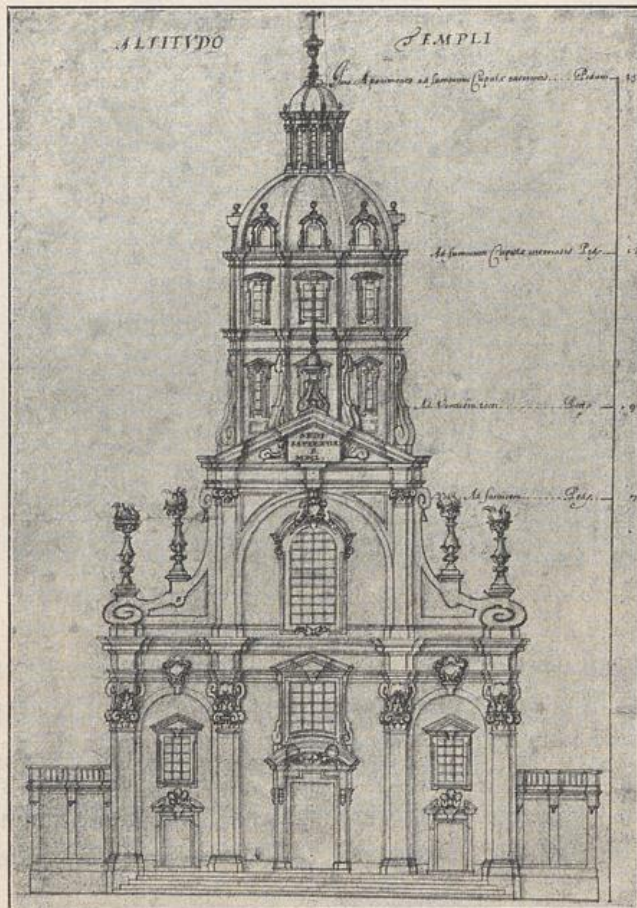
Löwen. Jesuitenkirche. Fassade.
